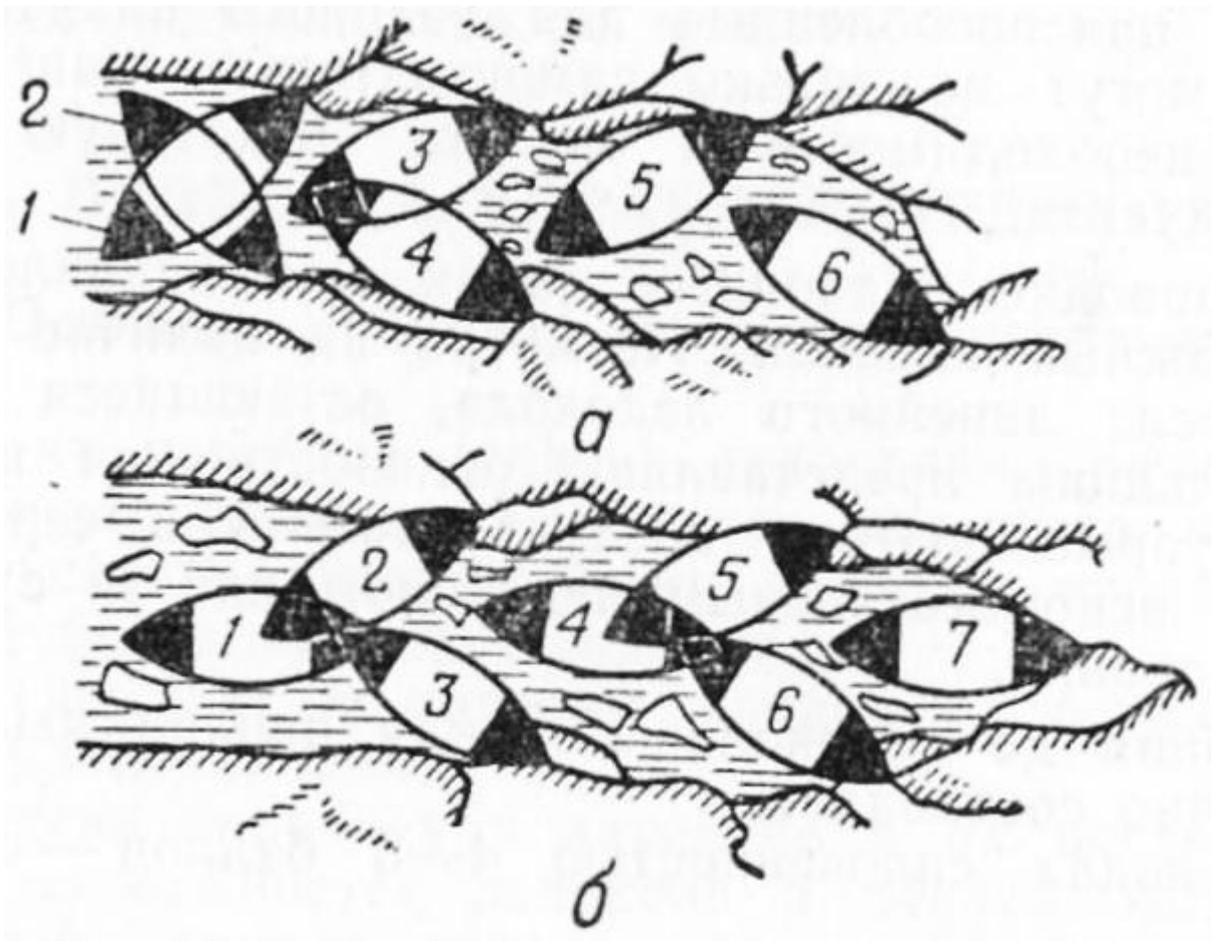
Схема расширения канала методом «елочка»: а — прокладка двойного канала; б — прокладка тройного канала
